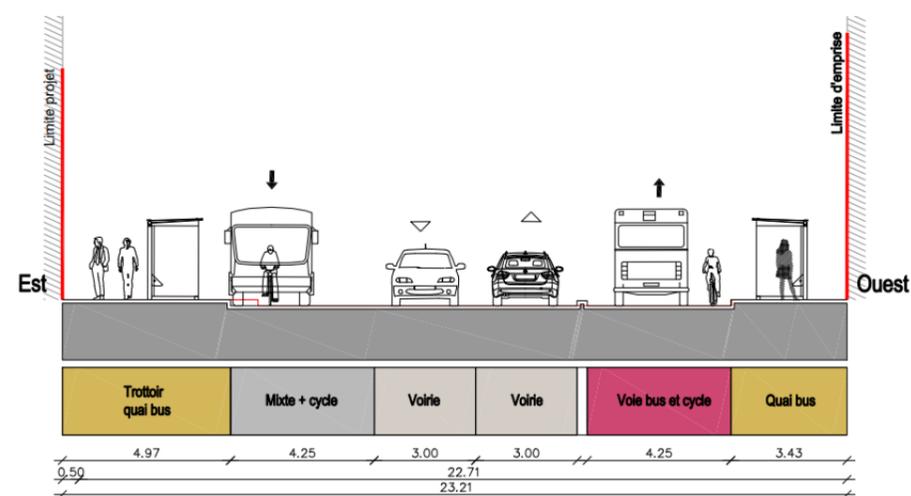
Coupe au droit de la station « De Gaulle » sur la RD48
